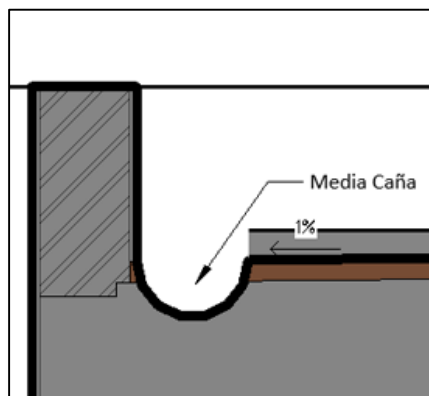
Detalle de drenaje pluvial. Fuente: Propia.
